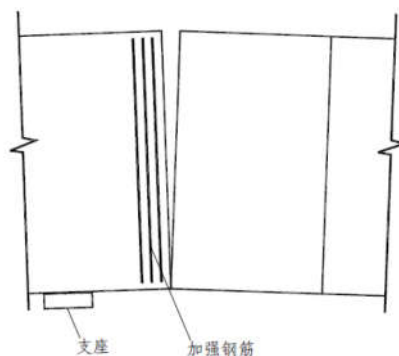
墩顶节段接缝旁的加强钢筋示意图
